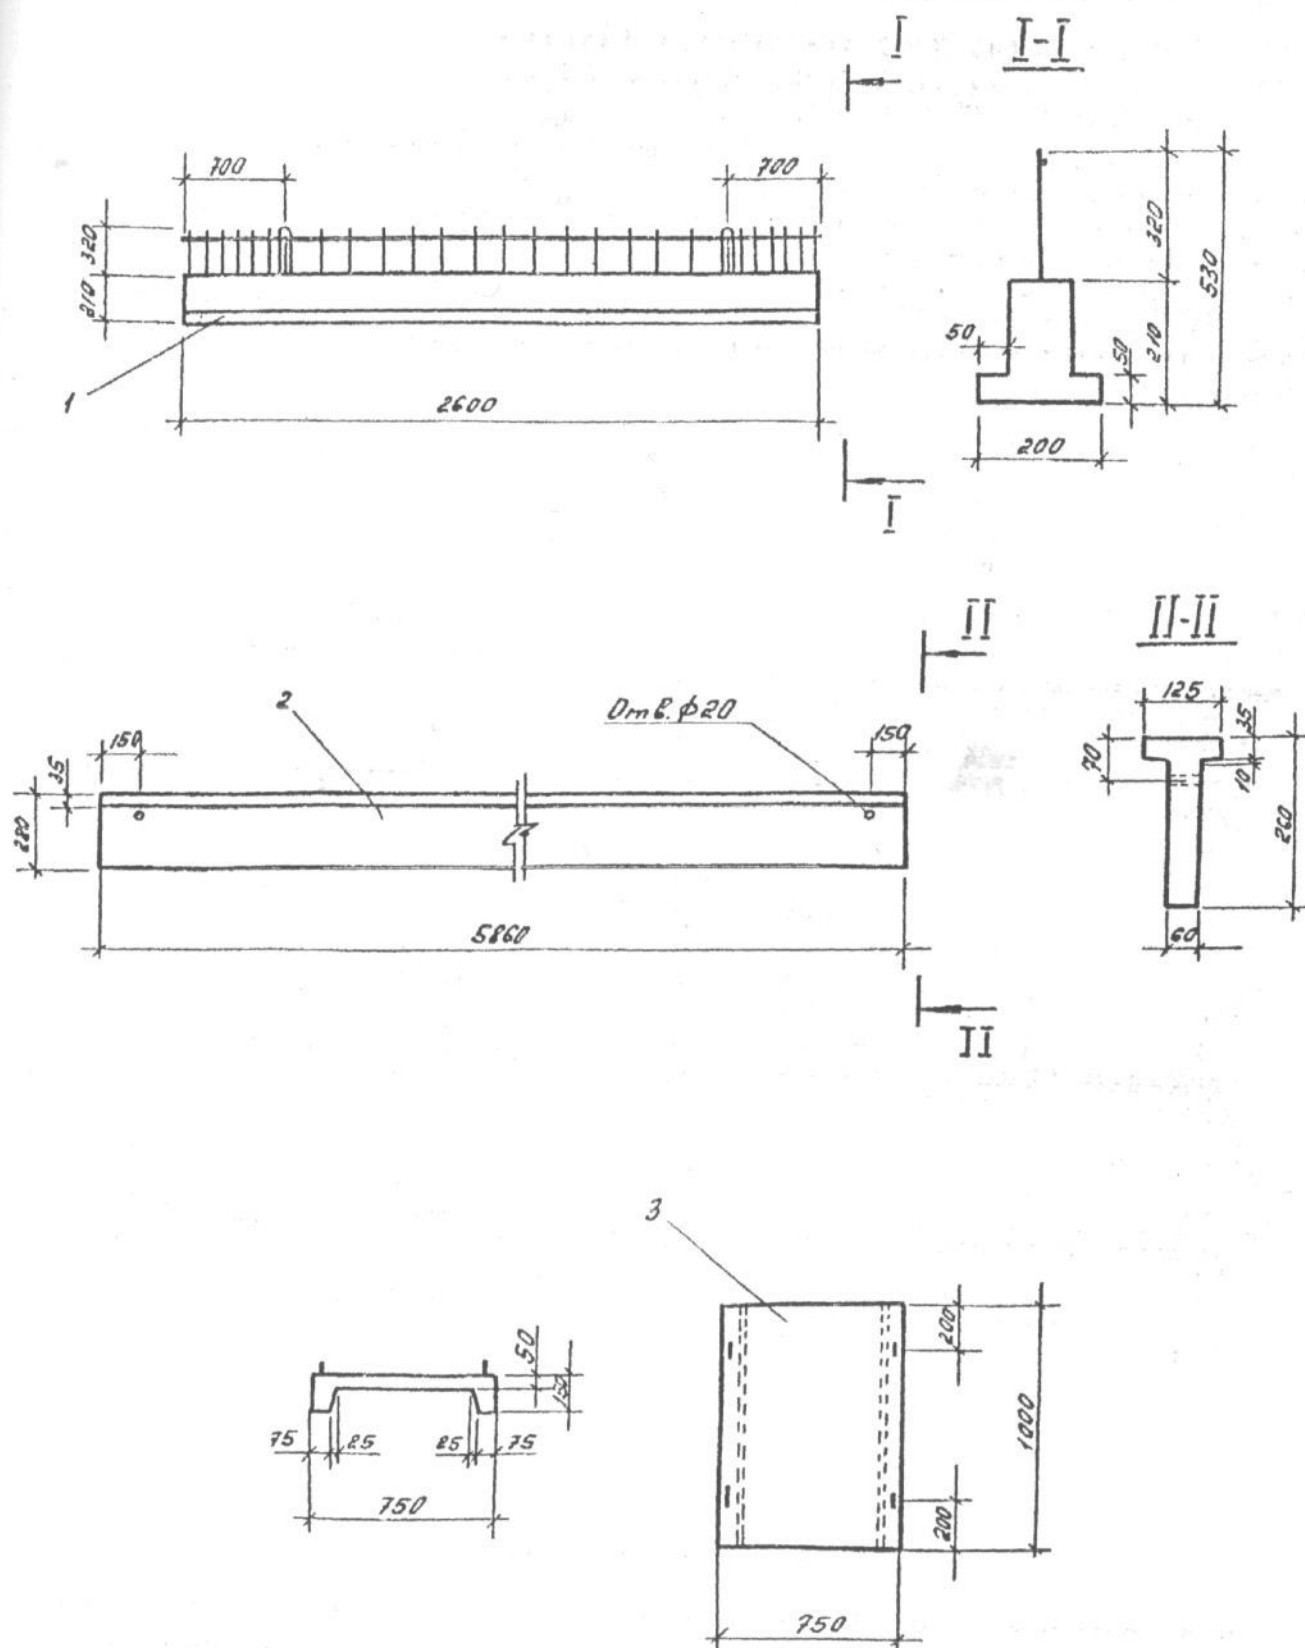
Сборные железобетонные конструкции чердачной крыши с мягкой кровлей из УТК
